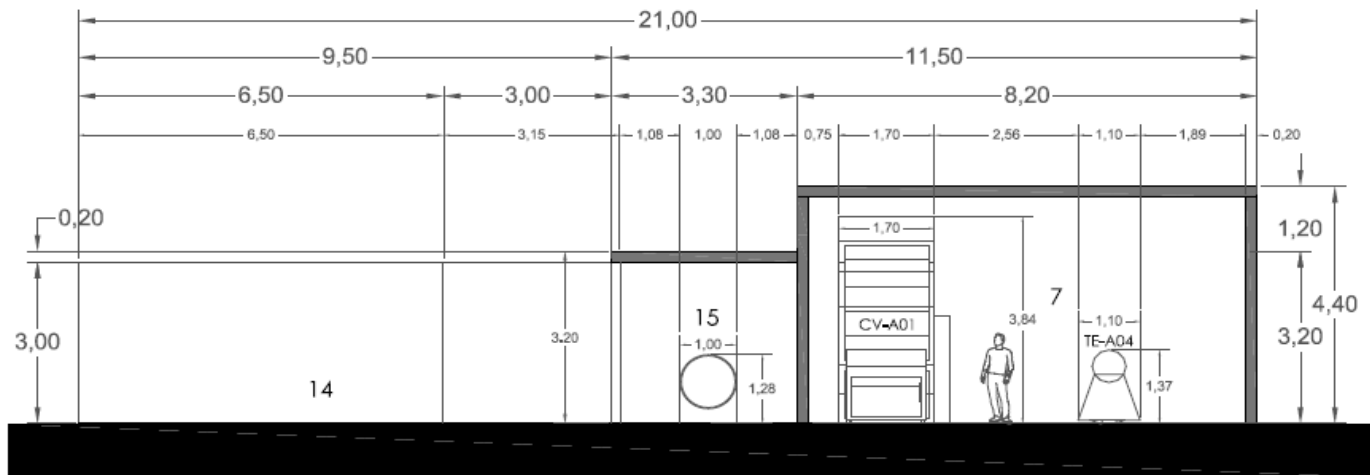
Vista del corte transversal de la planta productora de barras energéticas
